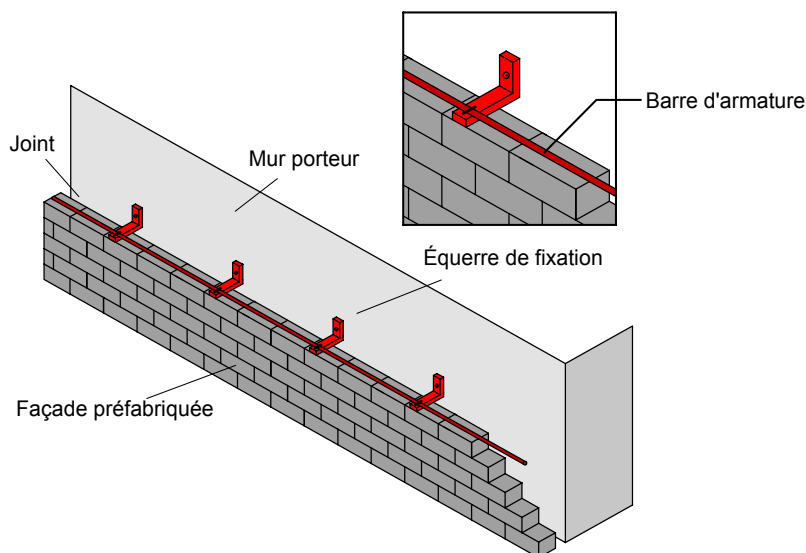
> Mesures applicables à des éléments préfabriqués en maçonnerie
